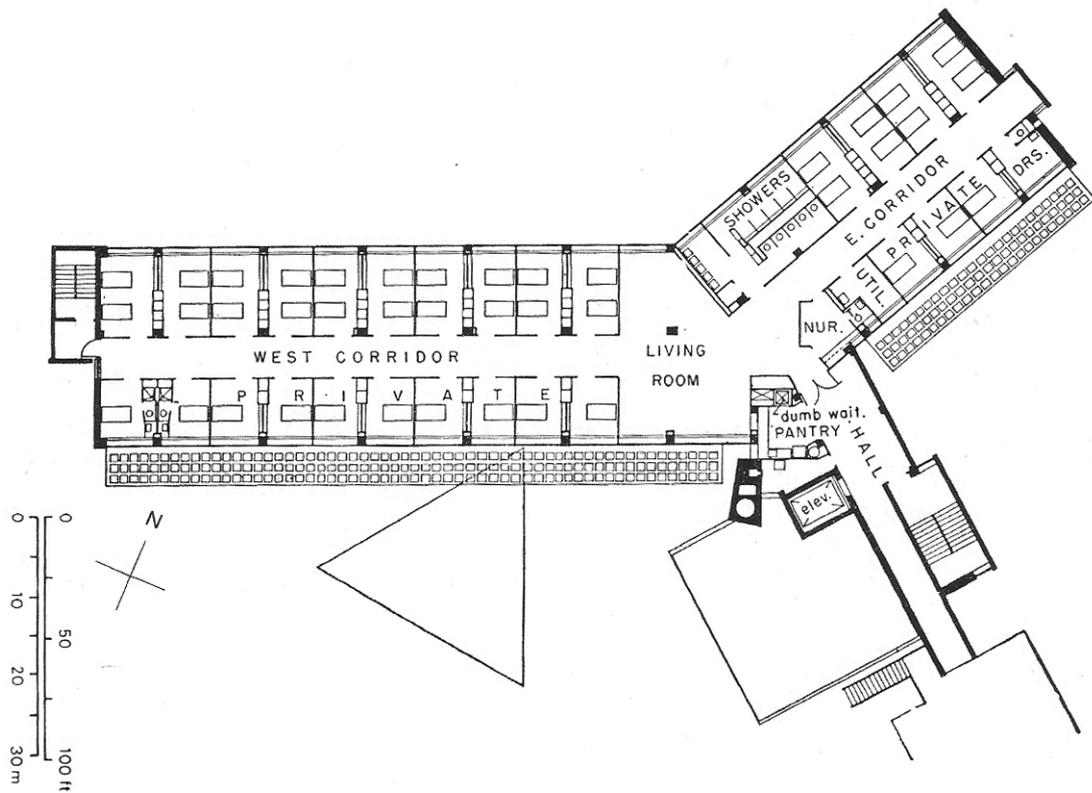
| Planta Radbill Building [BÜTTIKER]
